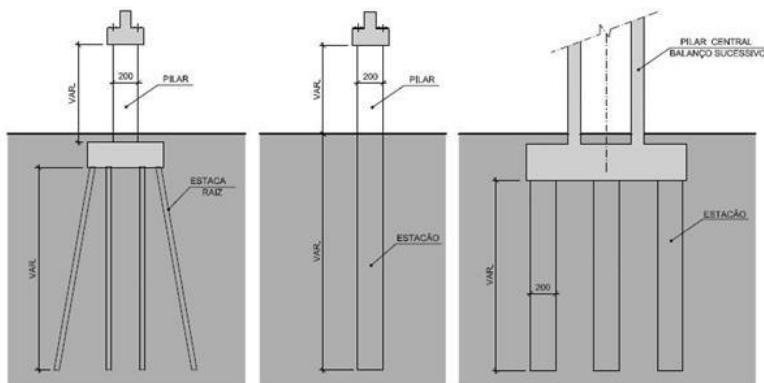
Alguns cortes transversais de fundações da via em elevado (medidas em centímetros) (CPTM, 2012)
